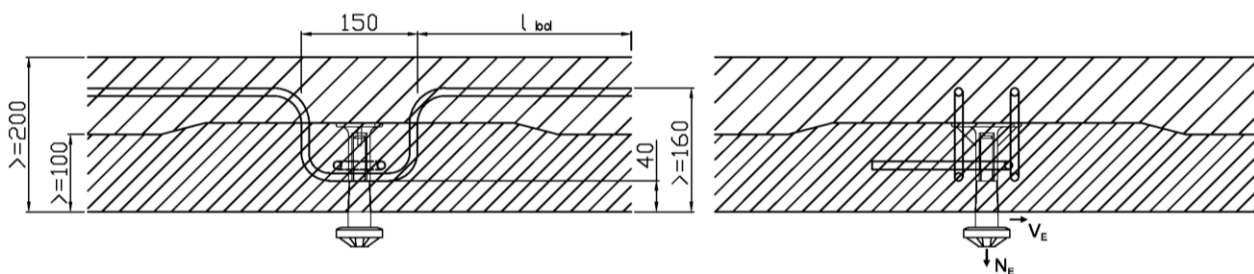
Einbauzustand im Fertigteil mit Ortbetonergänzung
